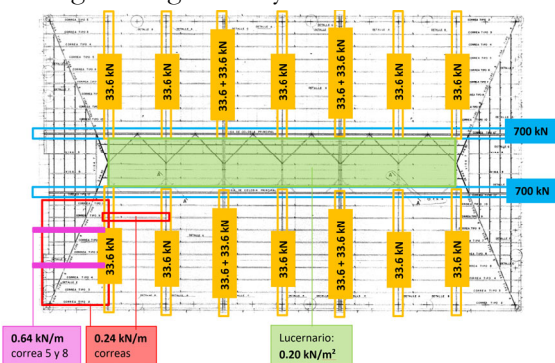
Resumen de cargas permanentes en vigas de nivel de cubierta.
